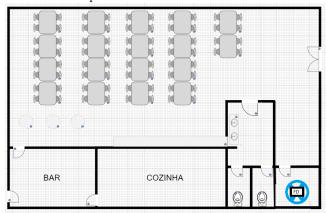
Planta da Cantina/Bar, Edifício 3
